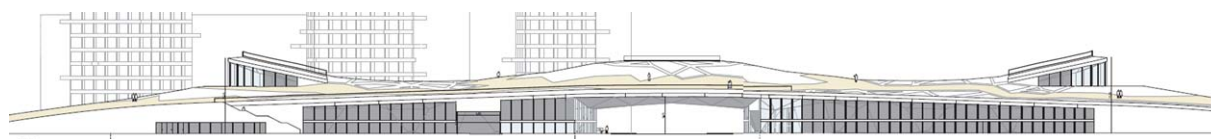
Sección longitudinal de las estaciones de FFCC (construida) y autobuses.
